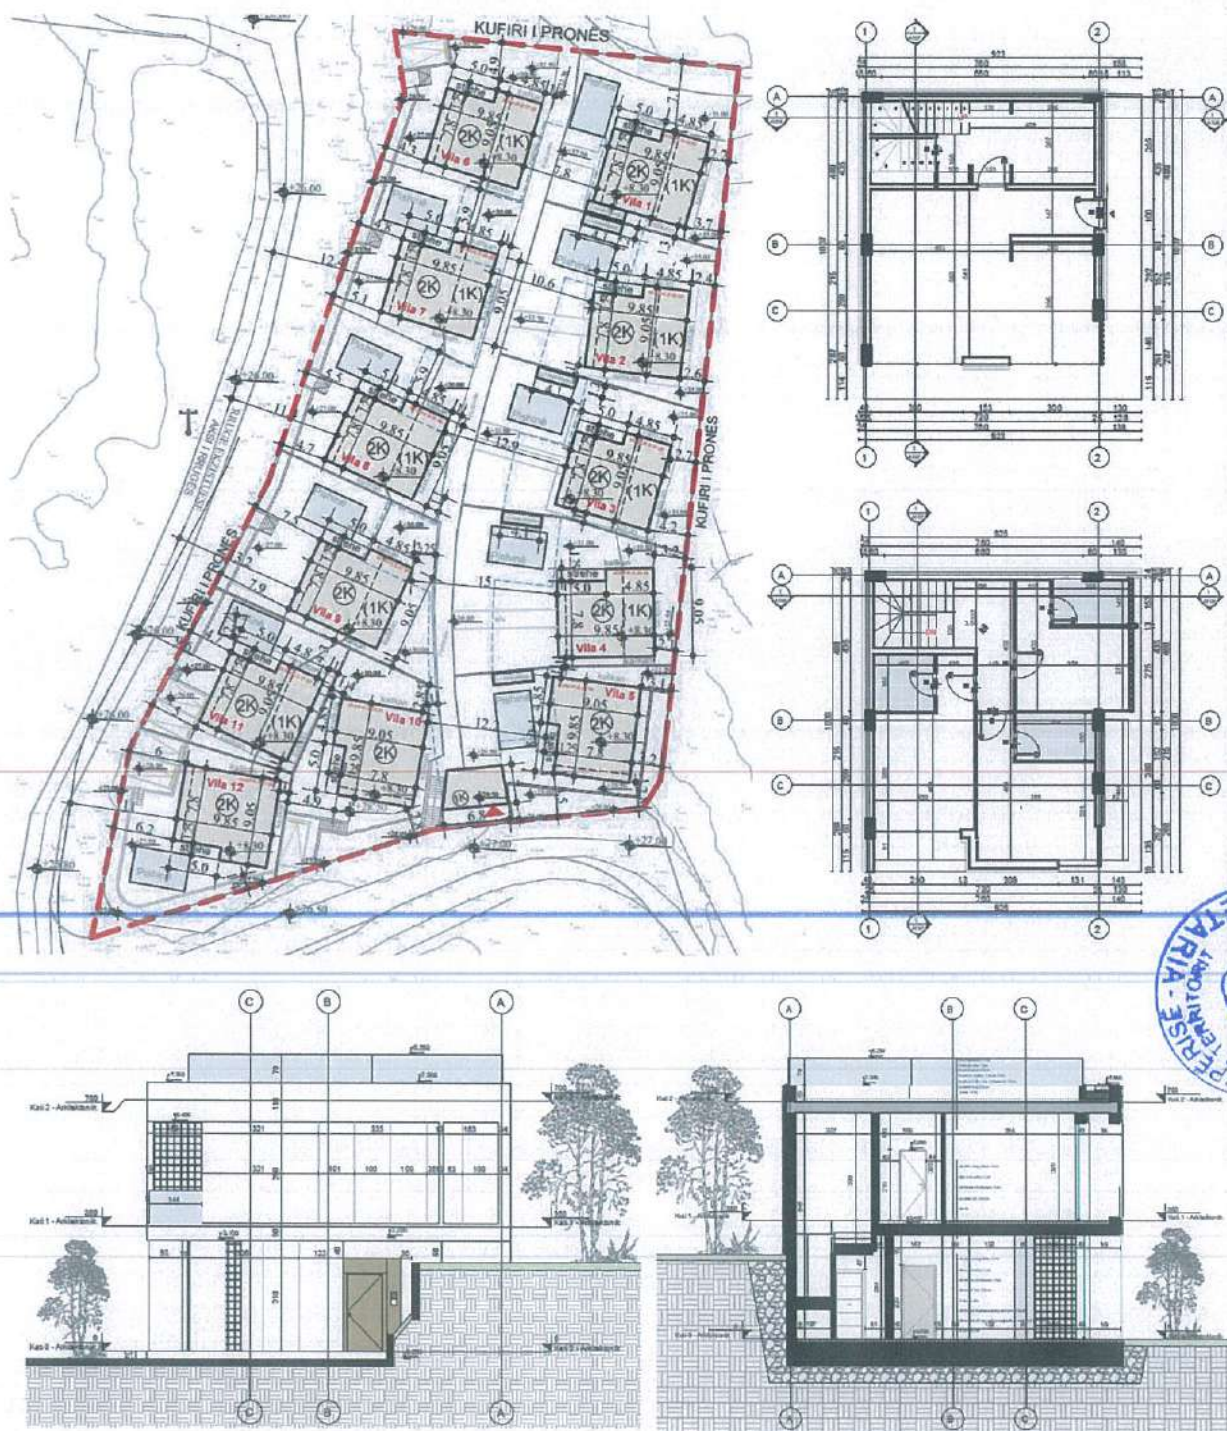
Planvendosja e vilave, planimetri, pamje dhe prerje
